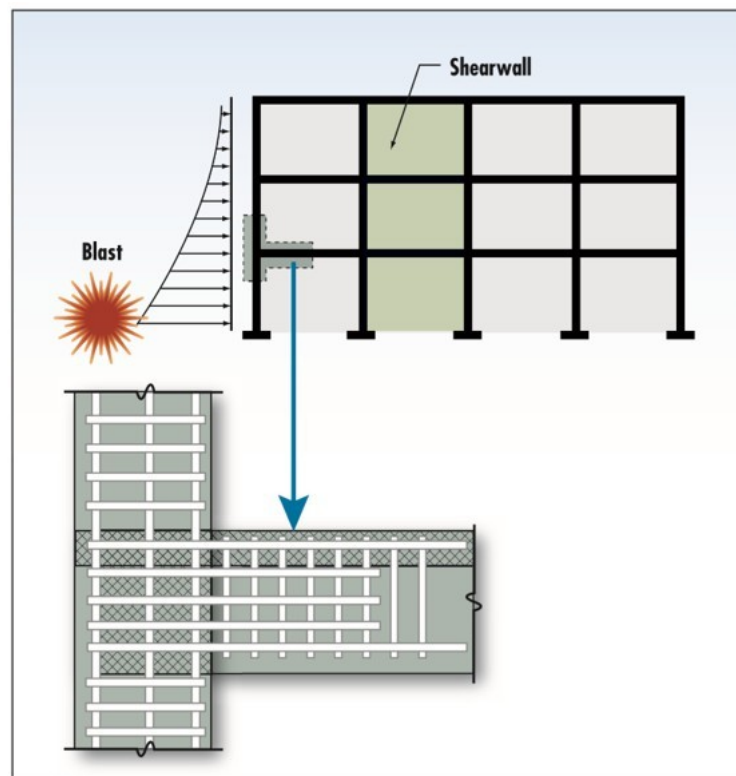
Додаткове армування вузлів залізобетонних елементів
